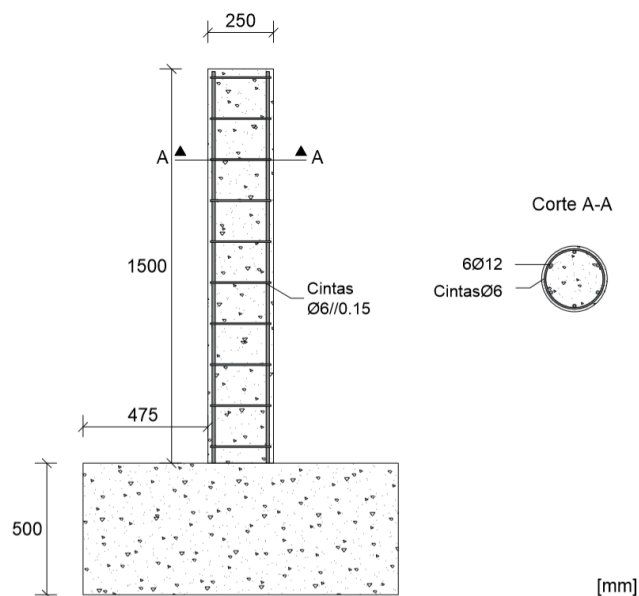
Características geométricas e pormenorização das armaduras dos pilares (adaptado de Chastre [9])
